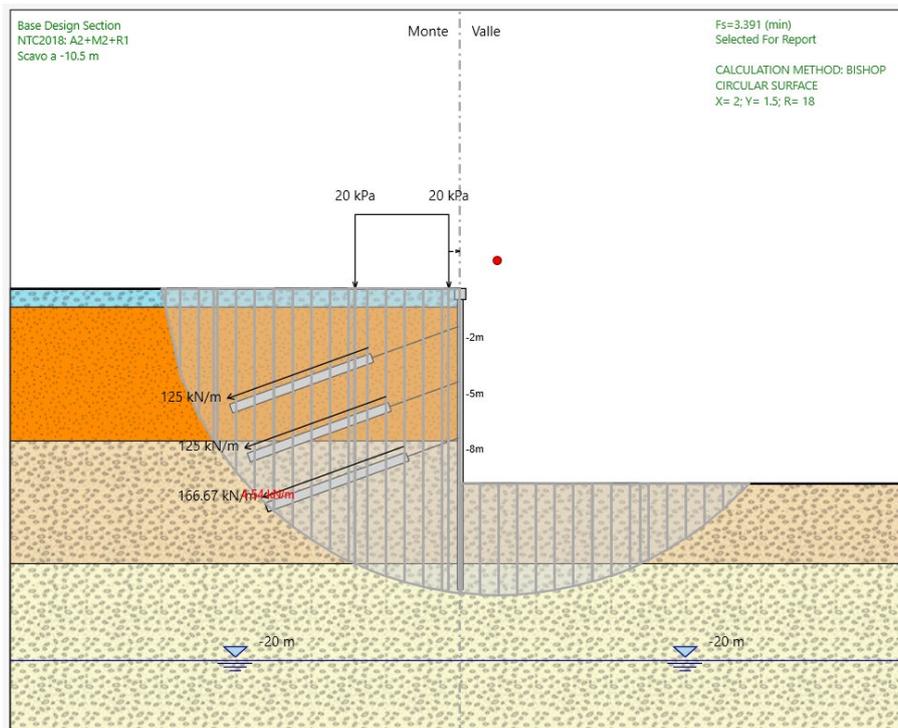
Sezione Tipo D - Condizioni statiche (FS=3.4)
